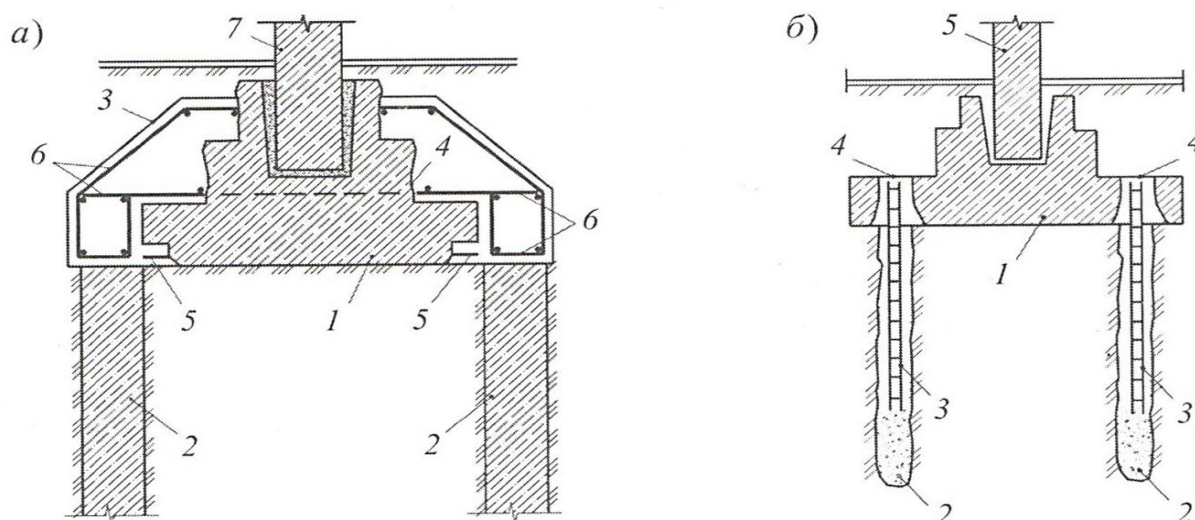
Способы сопряжения конструктивных элементов усиленного отдельного фундамента при передаче части нагрузки на инъекционные сваи (по данным Полищука А. И.) [55]:
